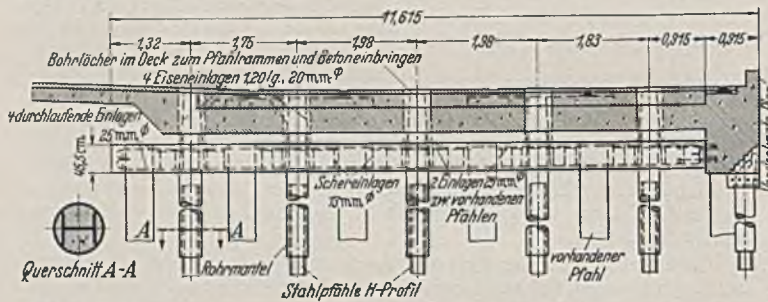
Querschnitt durch das Pierdeck mit seiner Verbindung mit den neuen Pfählen.
